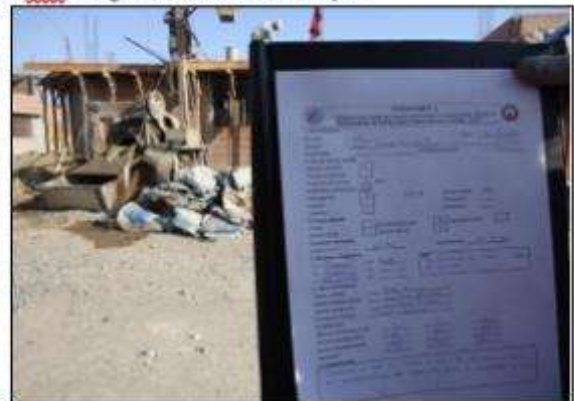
Construcción de vivienda Nro. 11 (V-11)
